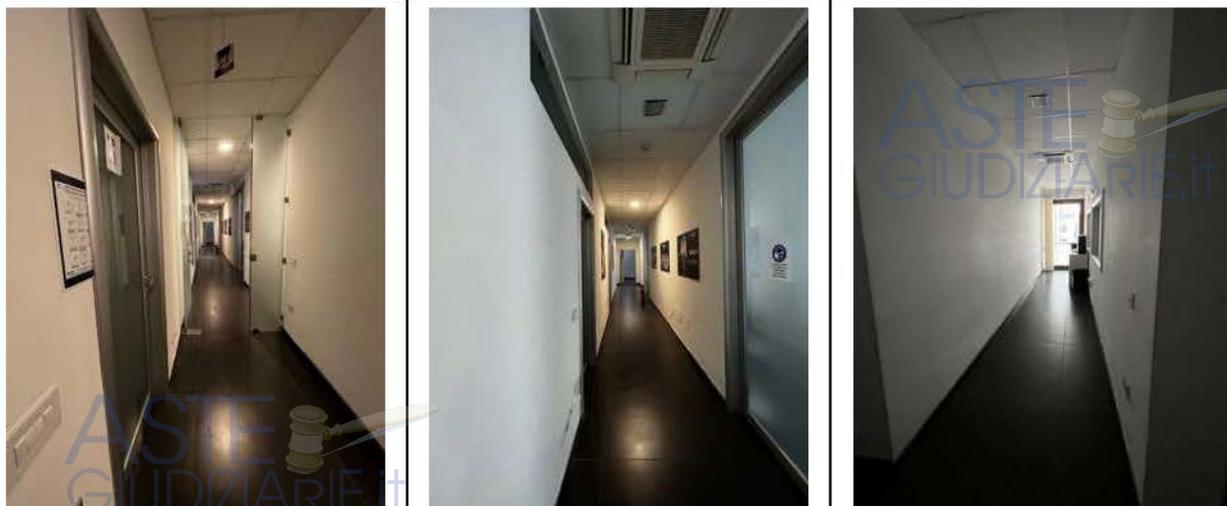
Corridoio di collegamento degli uffici posti sul lato nord - ovest del fabbricato. Si noti una maggiore separazioni degli ambienti destinati a specifiche attività.
